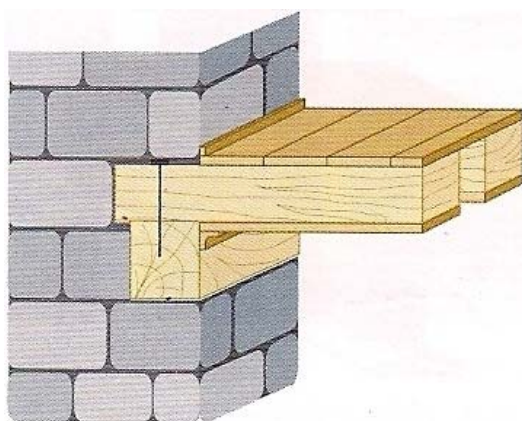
Liga  o pavimento-parede de alvenaria, com ancoragem da viga de madeira [1].
